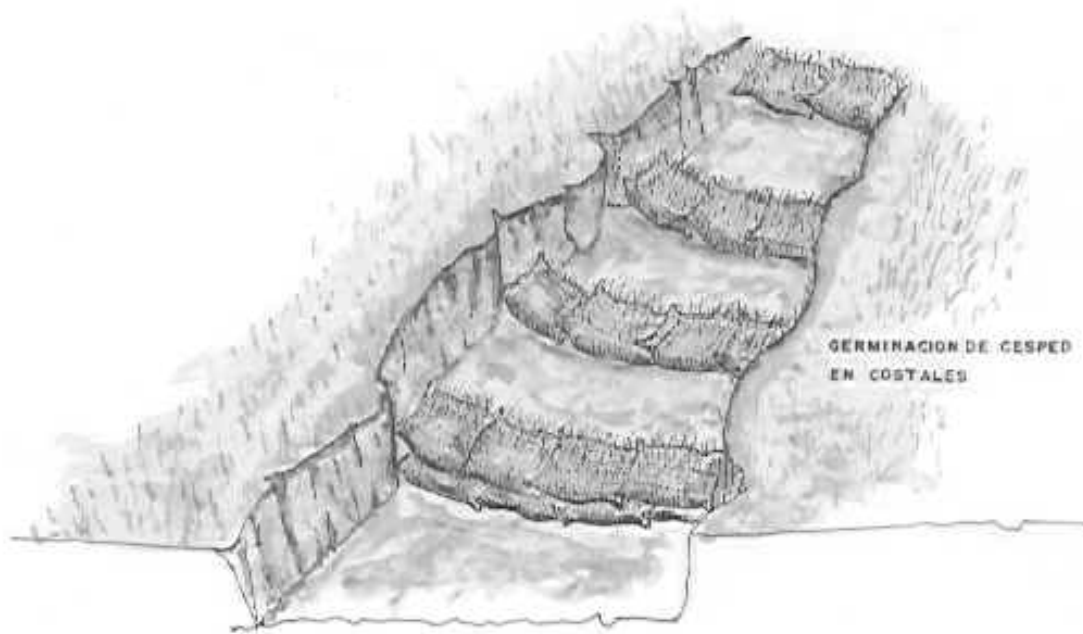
Fajas de césped (Adaptado de SCS, 1973)
